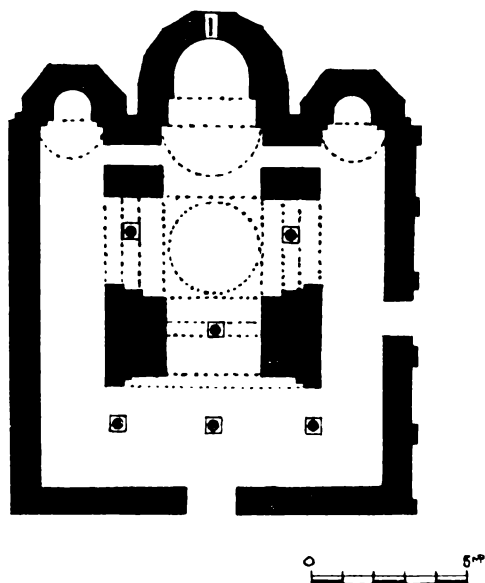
Grundriss der Kirche von Drenovo.
